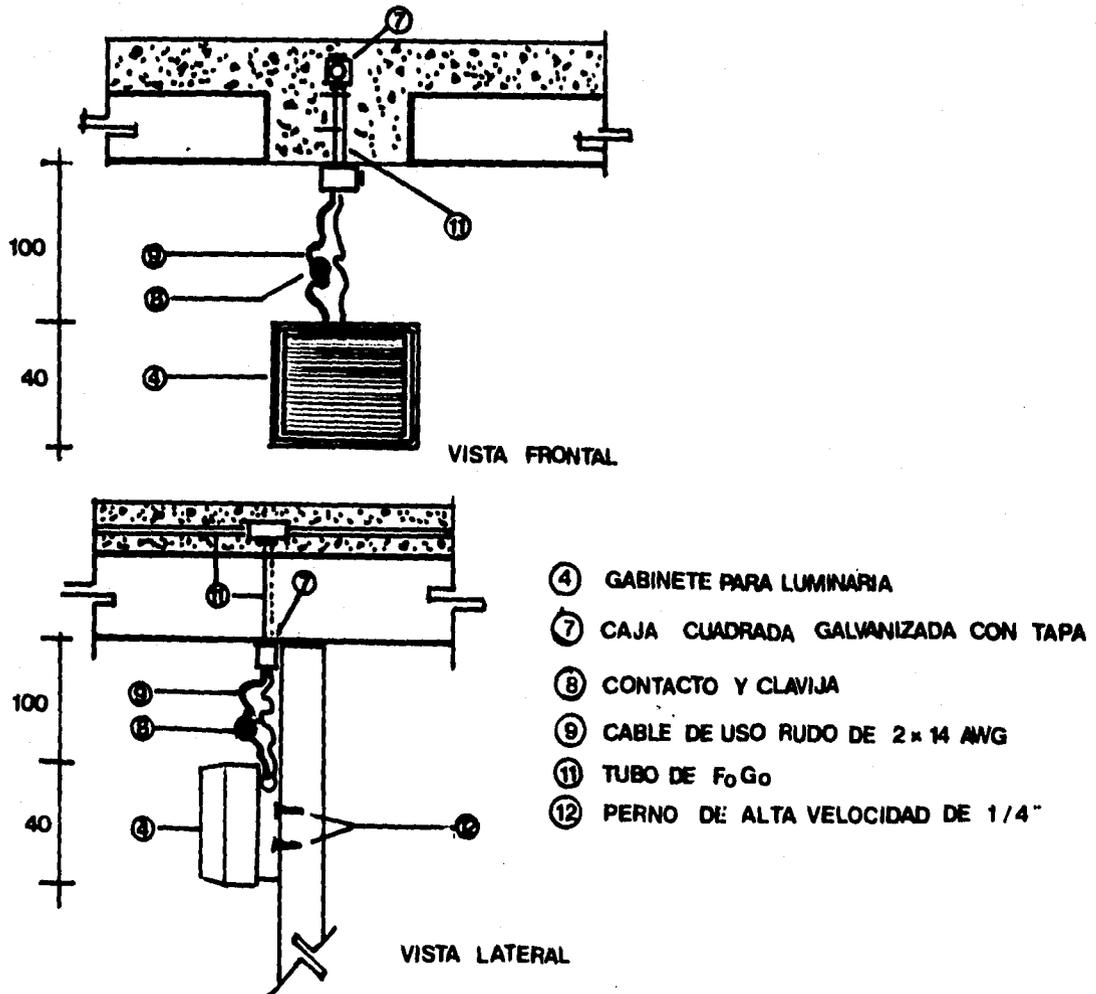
ALUMBRADO BAJO EL PUENTE
